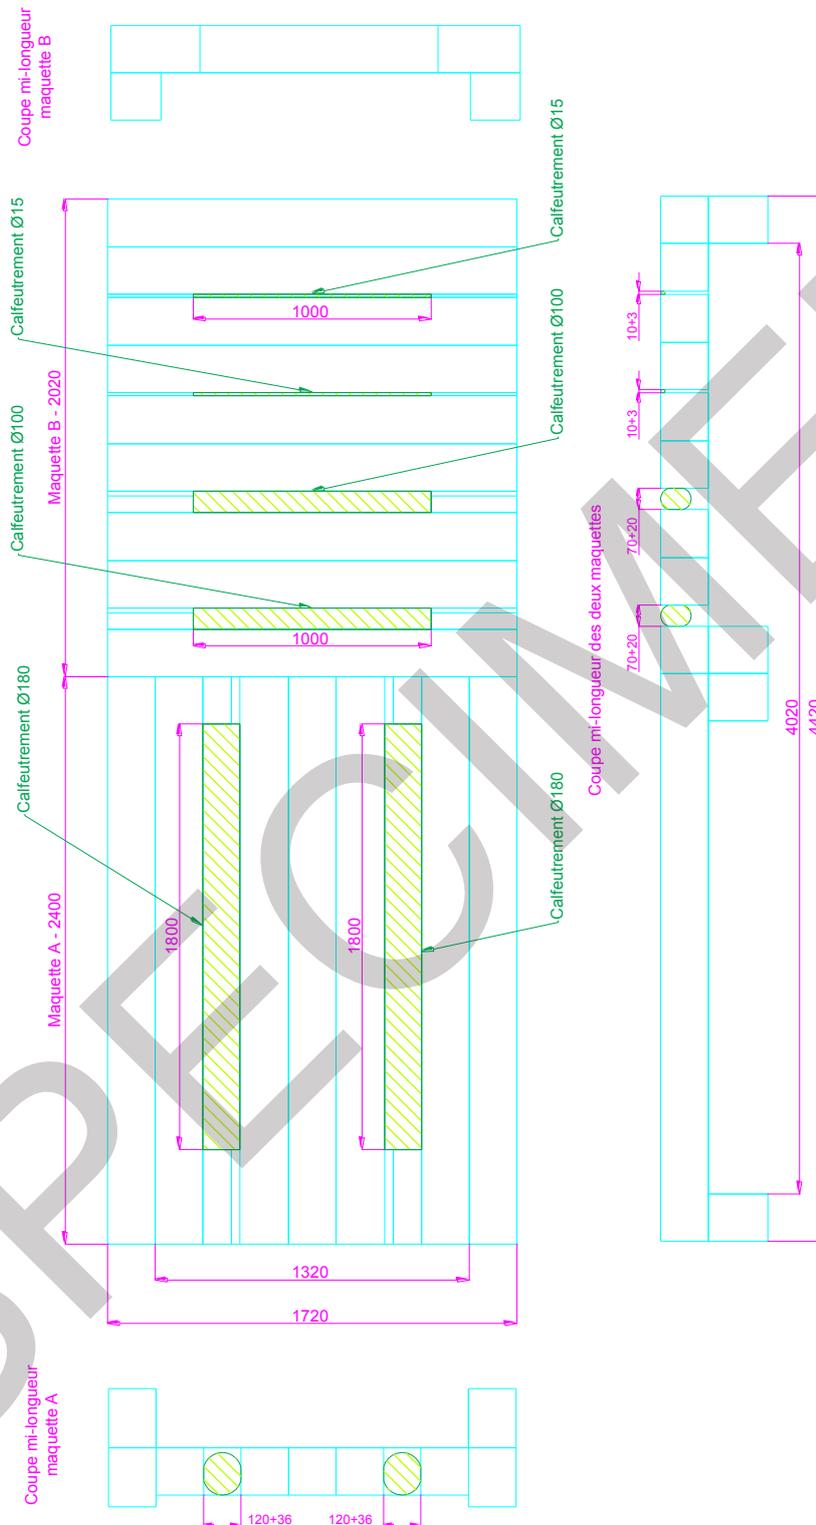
Mise en œuvre de joints linéaires dans une construction support horizontale
